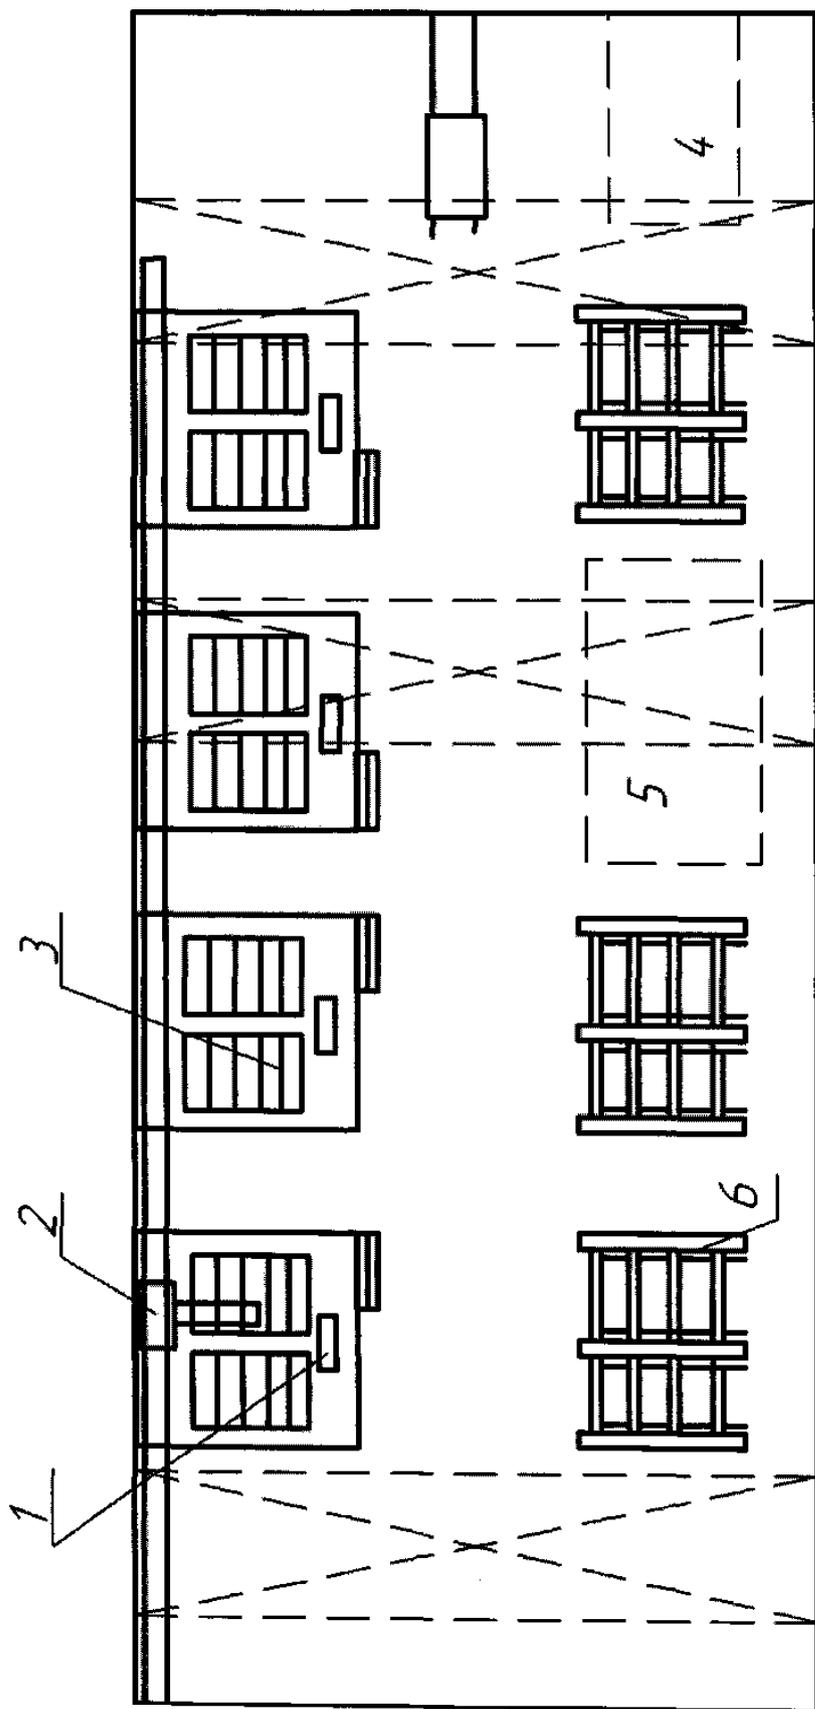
Схема кассетного производства панелей внутренних стен, перегородок и панелей перекрытия:
